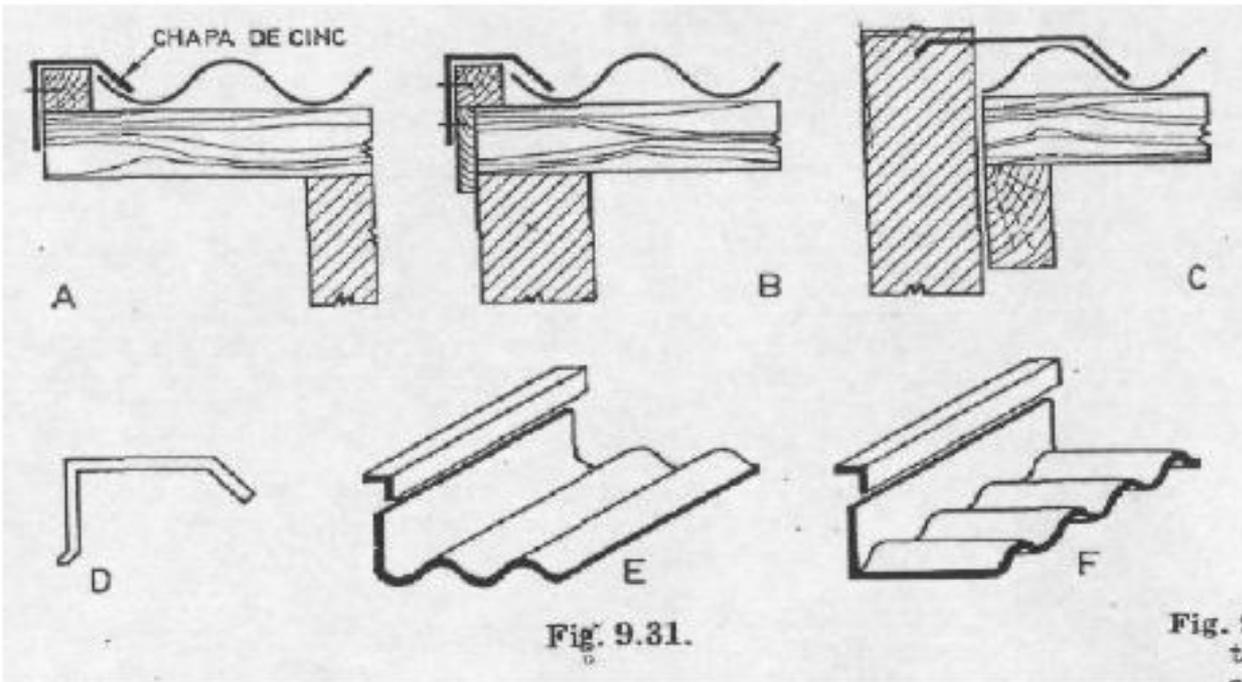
Cubierta de chapa ondulada, detalles de terminación
